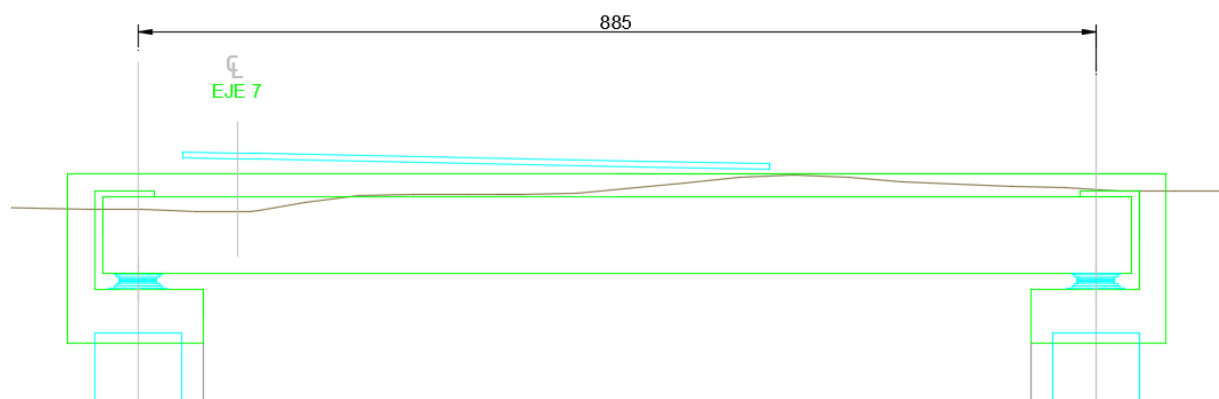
Alzado de viga. Fuente: IDOM-DEHC.
